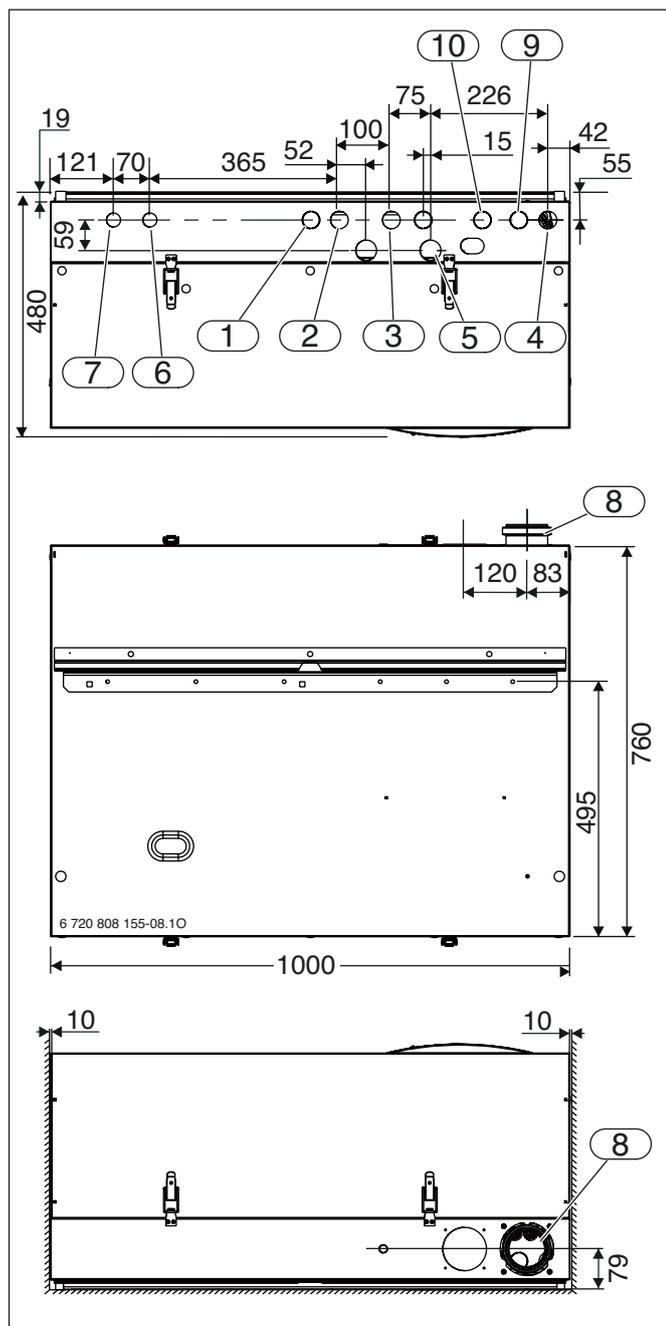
THR 2-17/5-25 M75 H e THR 2-17 M75 H DC (dimensioni in mm)
